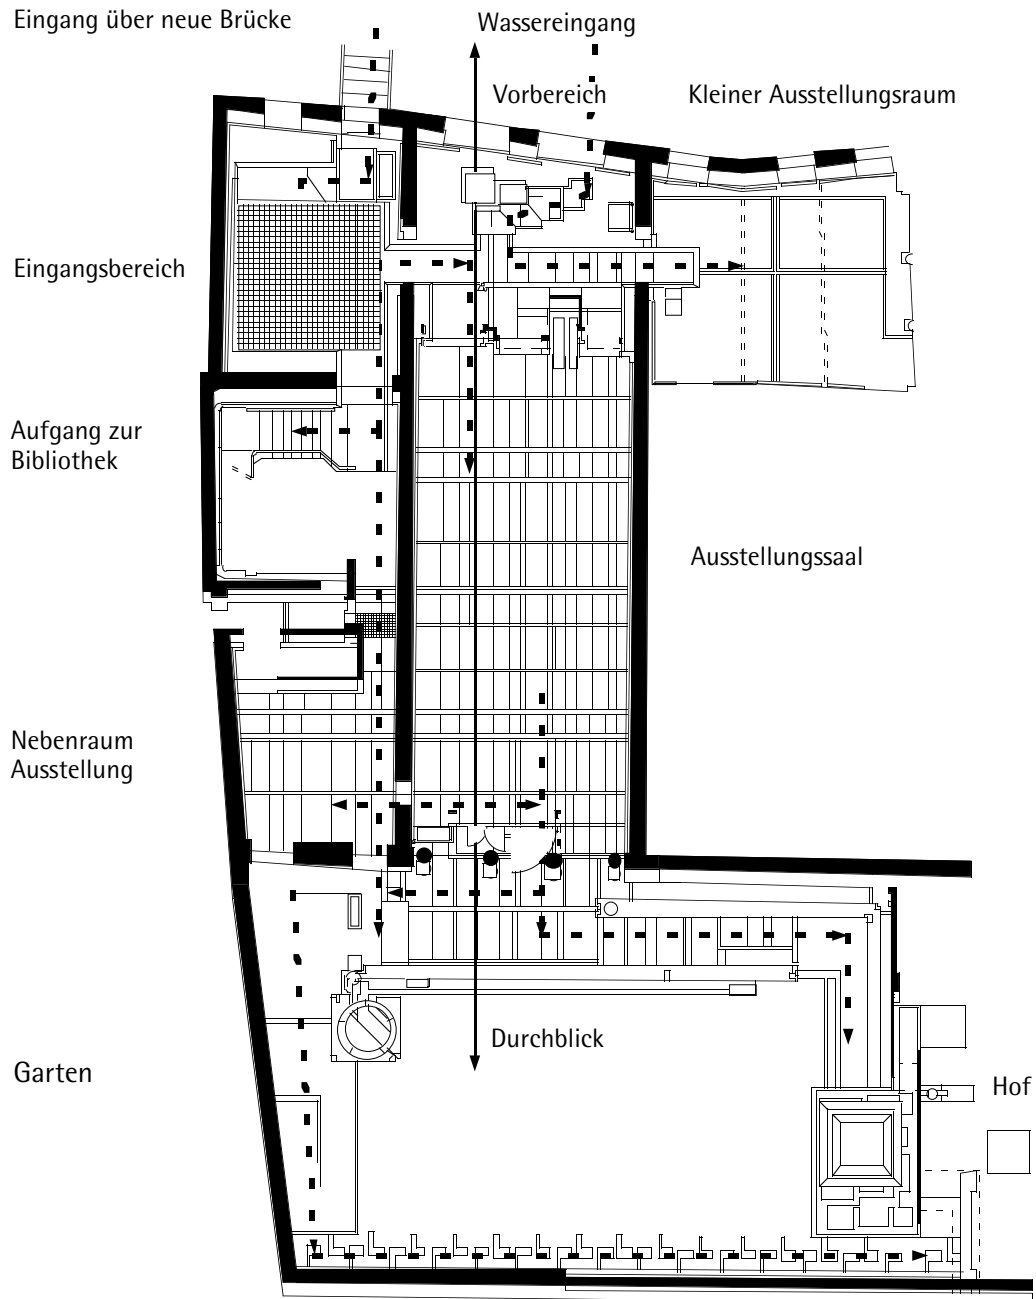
Grundriß Erdgeschoß, Funktionen und Erschließung
